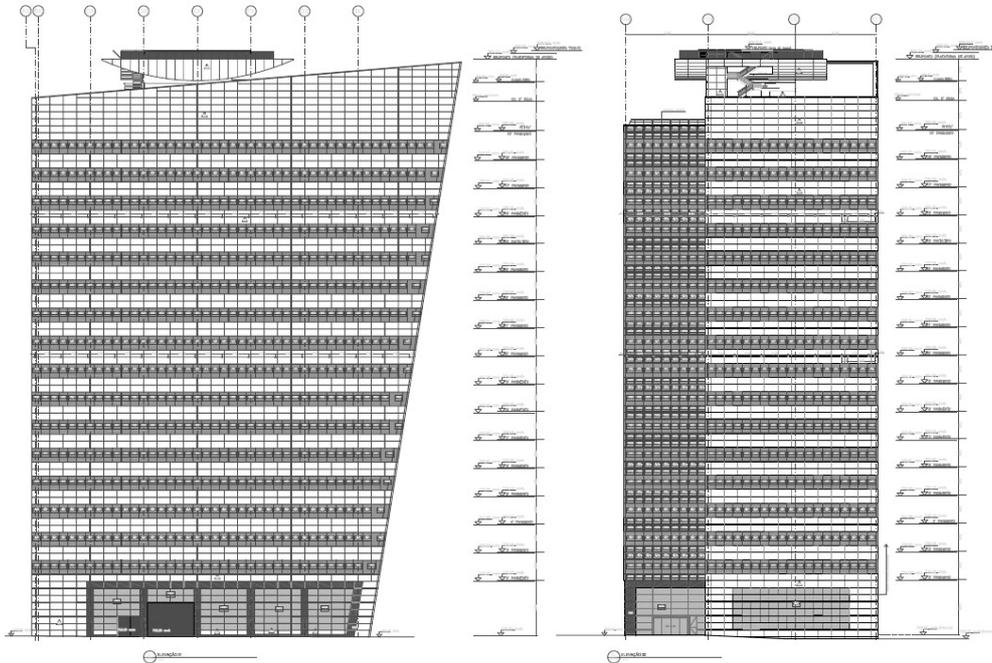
Projeto da fachada das torres A e B – Empreendimento “R”
